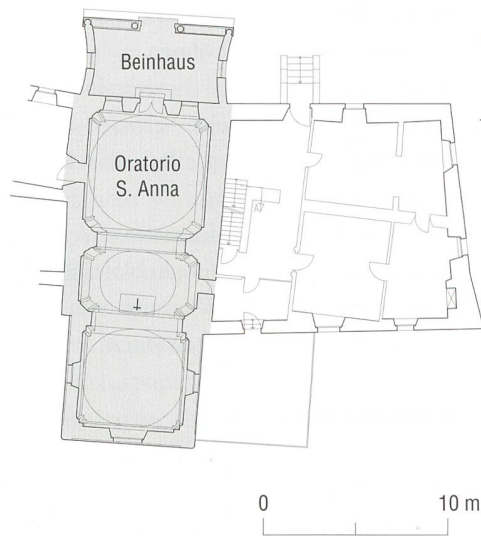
Poschiavo, Oratorio S. Anna. Grundriss mit dem Beinhaus. Mst. 1:400.
